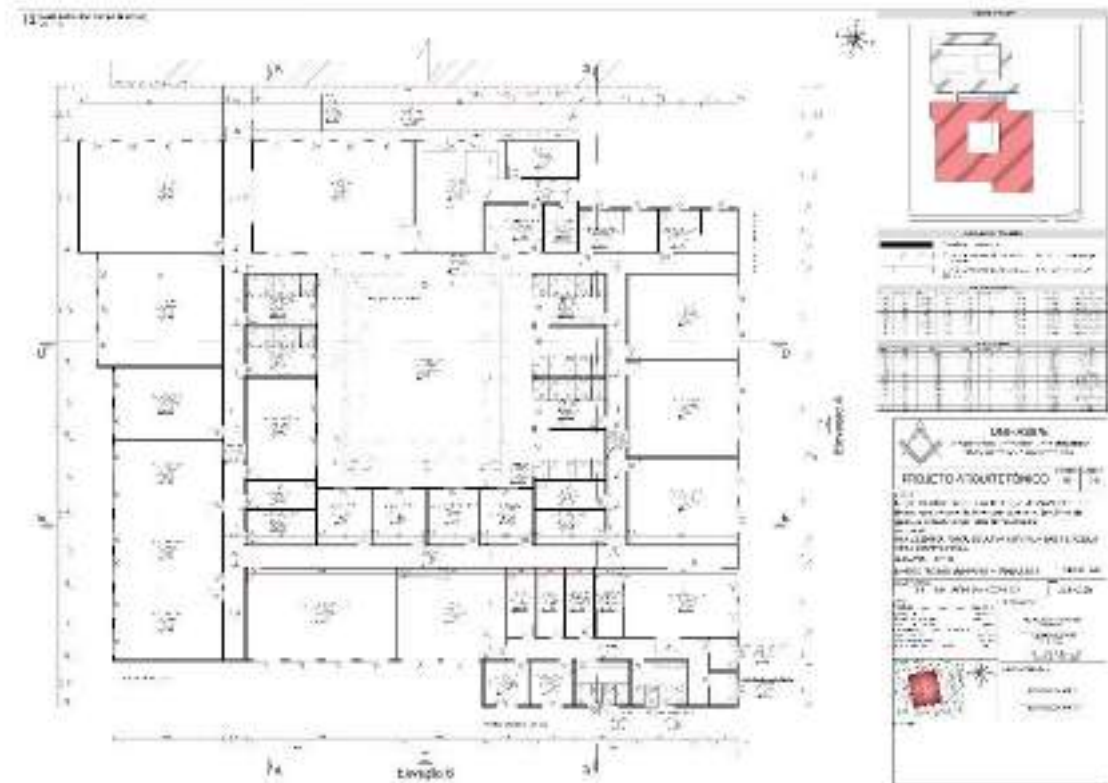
Prancha 03 - Planta layout da edificação principal
